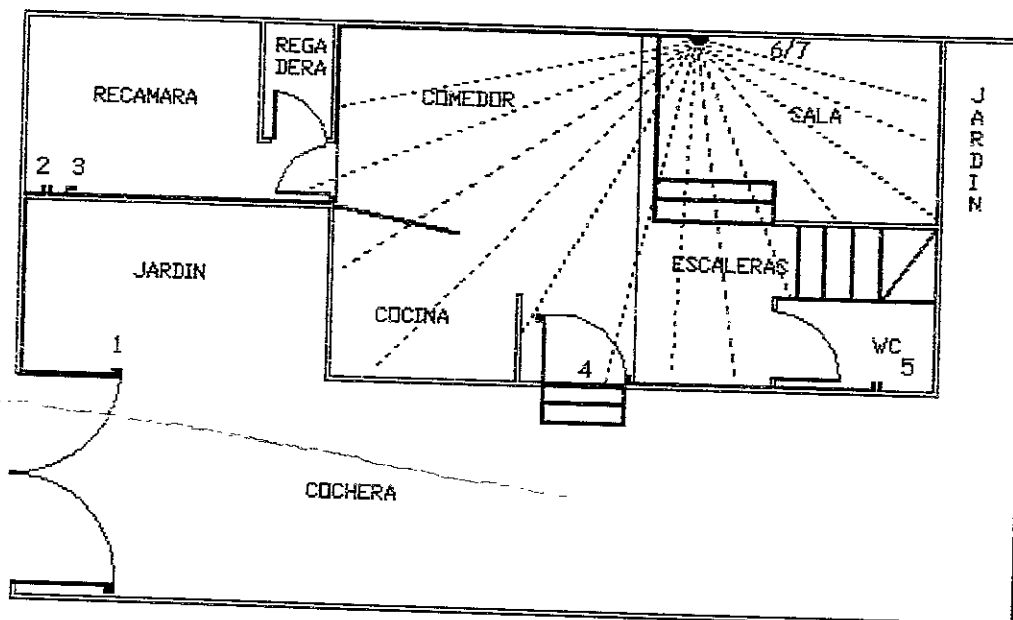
Croquis de la Planta Baja de la casa habitación.
